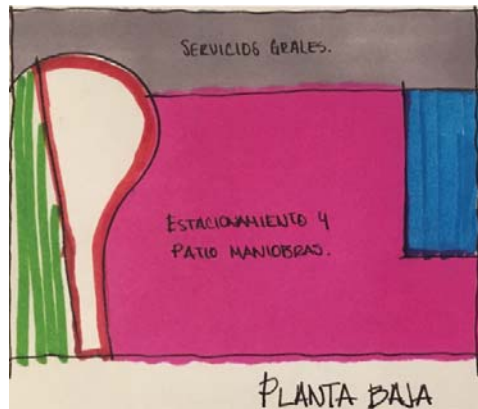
Esquema de disposición Estación de Bomberos "Ave Fénix". Planta Baja. Croquis personal
